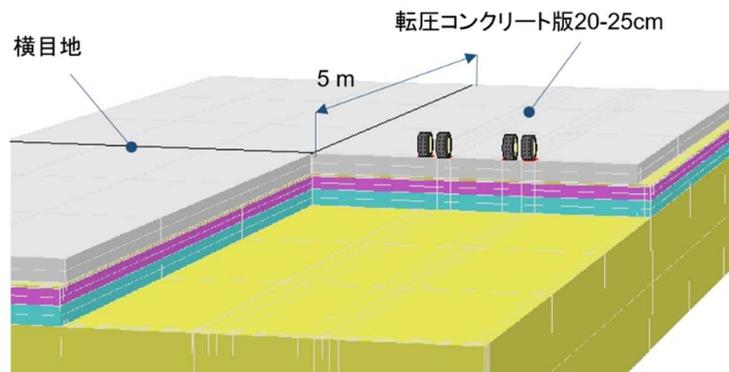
転圧コンクリート舗装 (RCCP) の構造
